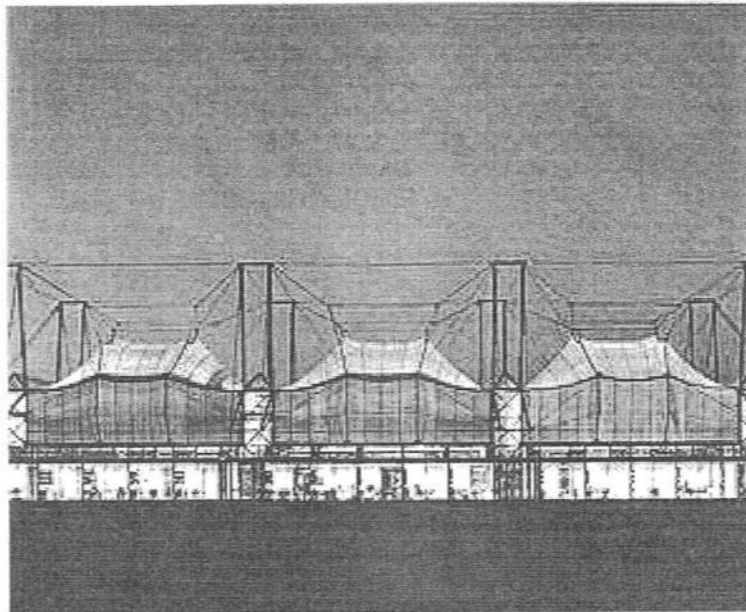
a y b: La estructura de la cubierta es el elemento que caracteriza la particular imagen de este edificio.
